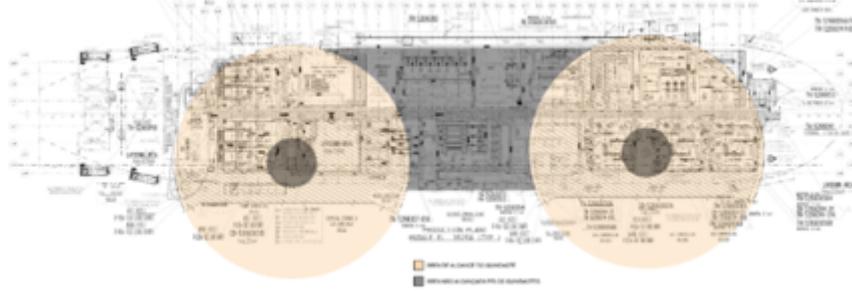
Guindastes não se comunicam e têm uma área ao centro da planta inacessível
